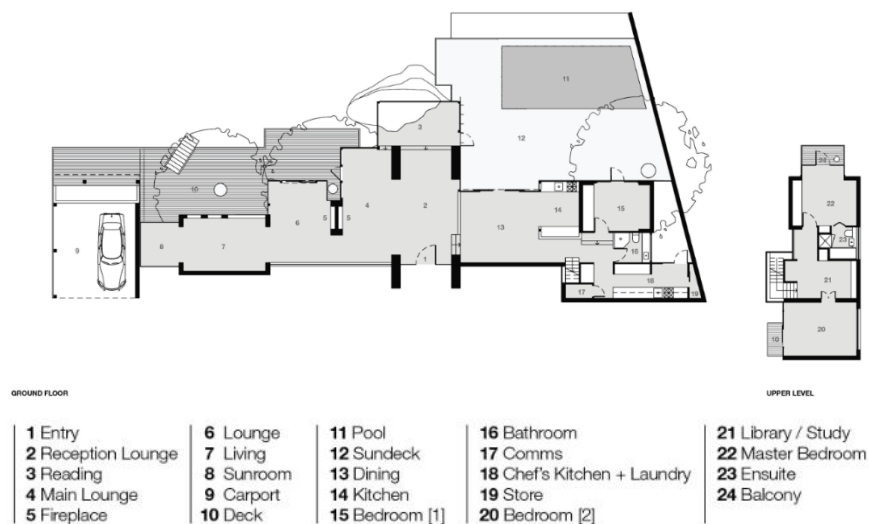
Planta de distribución Casa Bynya Fotografía: Michael Nicholson
